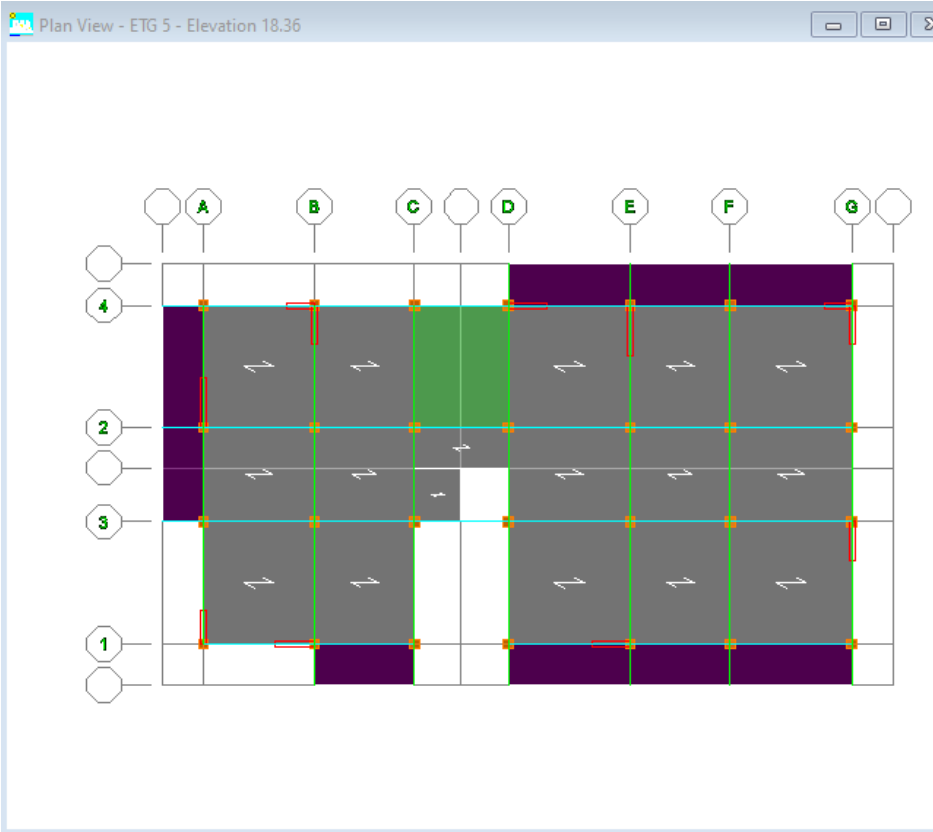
Vue en plan des éléments structuraux d'un étage.
